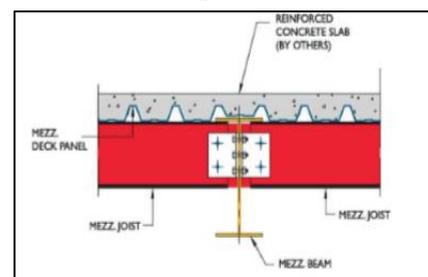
Assemblage poutre-dalle (Source: PRE-ENGINEERED BUILDING-pdf)
